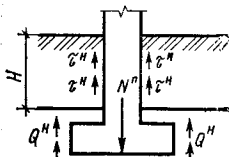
Схема действия на фундамент касательных сил морозного пучения
